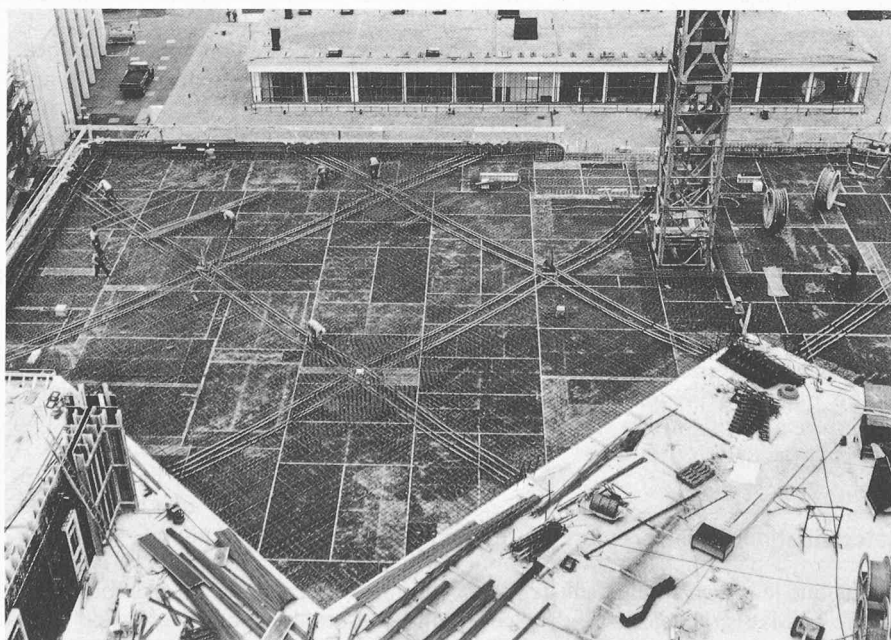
Dalle plate précontrainte en bandes d'appui (photo en stade de construction).
